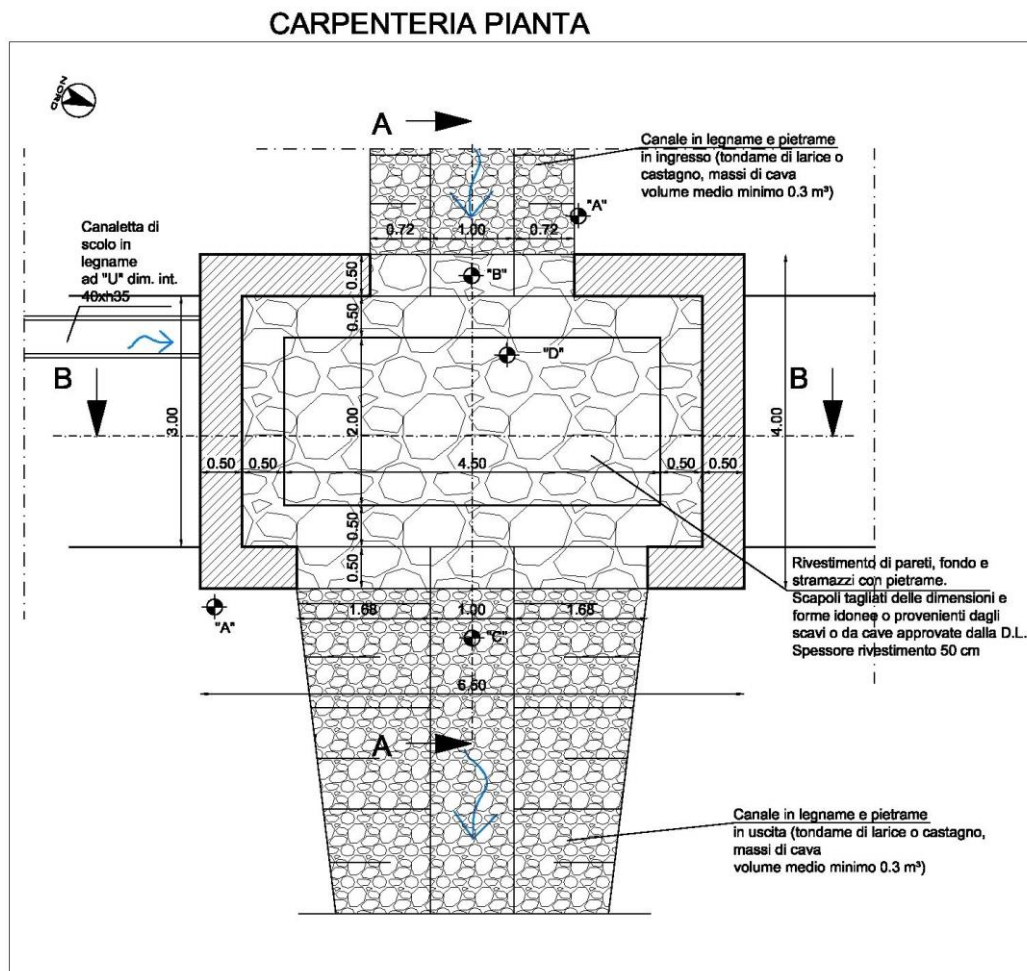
Compluvio centrale – Vasca tipo Vi2-3-4-5-6 - pianta
